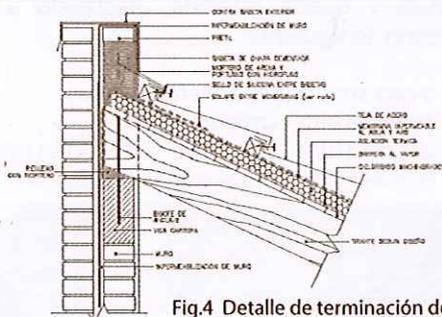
Detalle de terminación de pretil con babeta metálica y apoyo de viga en un muro de ladrillo visto
